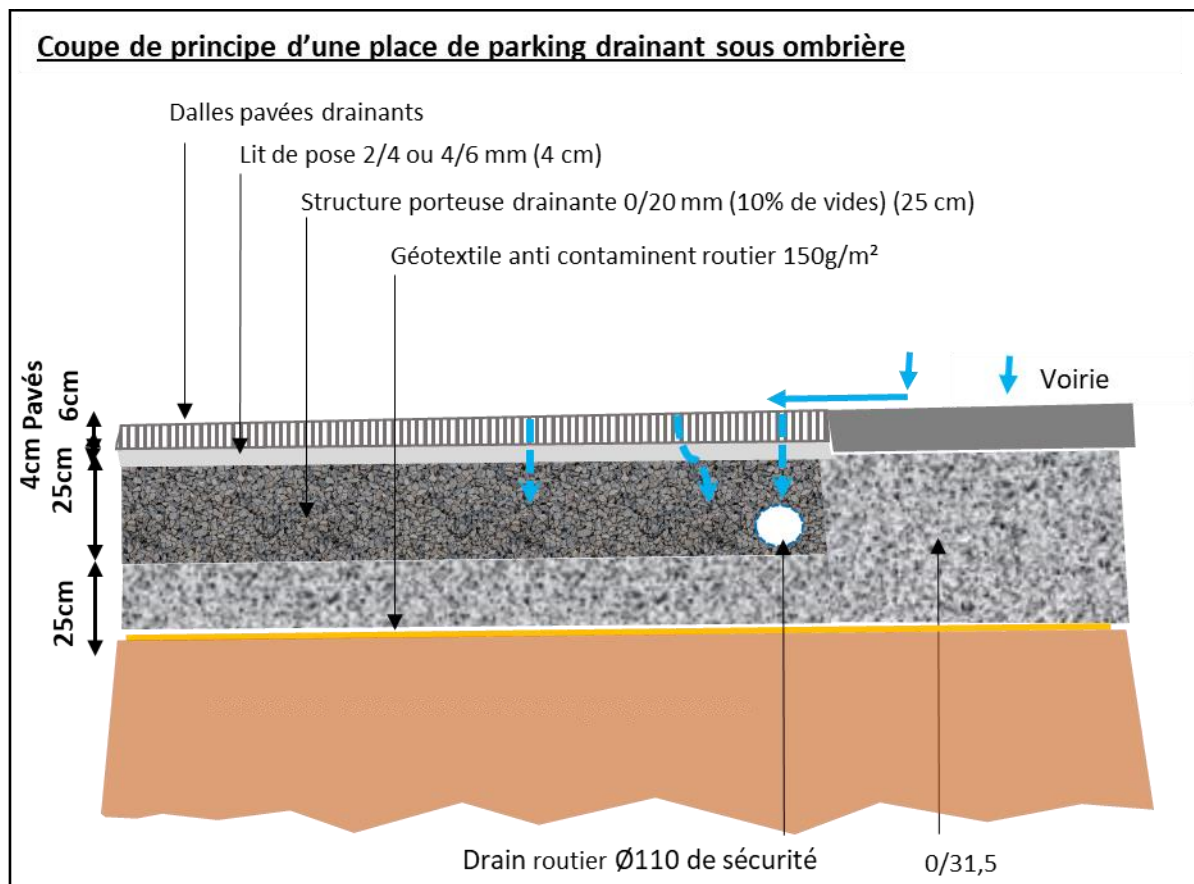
Principe de mise en œuvre des dalles pavées infiltrantes
